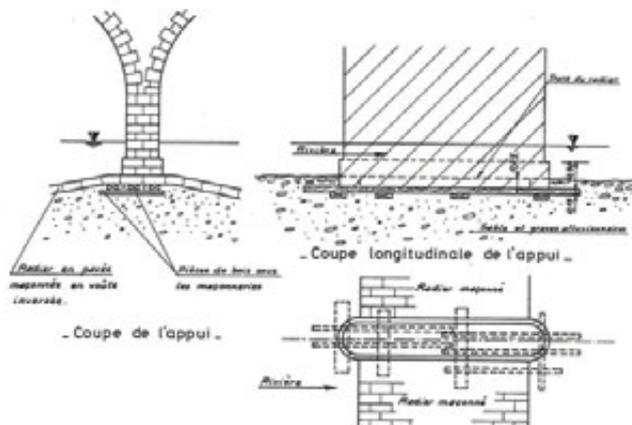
Pile centrale du pont de Chasseneuil-du-Poitou sur le Clain. Relevé des bois de fondation de la semelle lors de l'érosion du lit par affouillement en aval par effet de seuil (crédit J-P Levillain)
